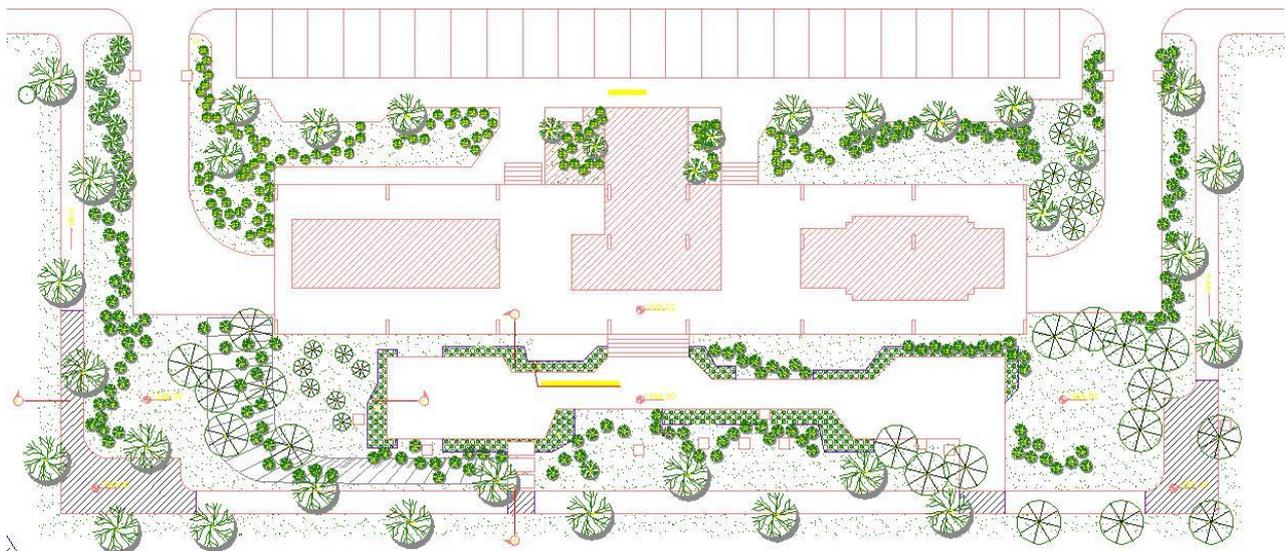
Localização de passarelas – Planta digitalizada. (Fonte: LEAC).
